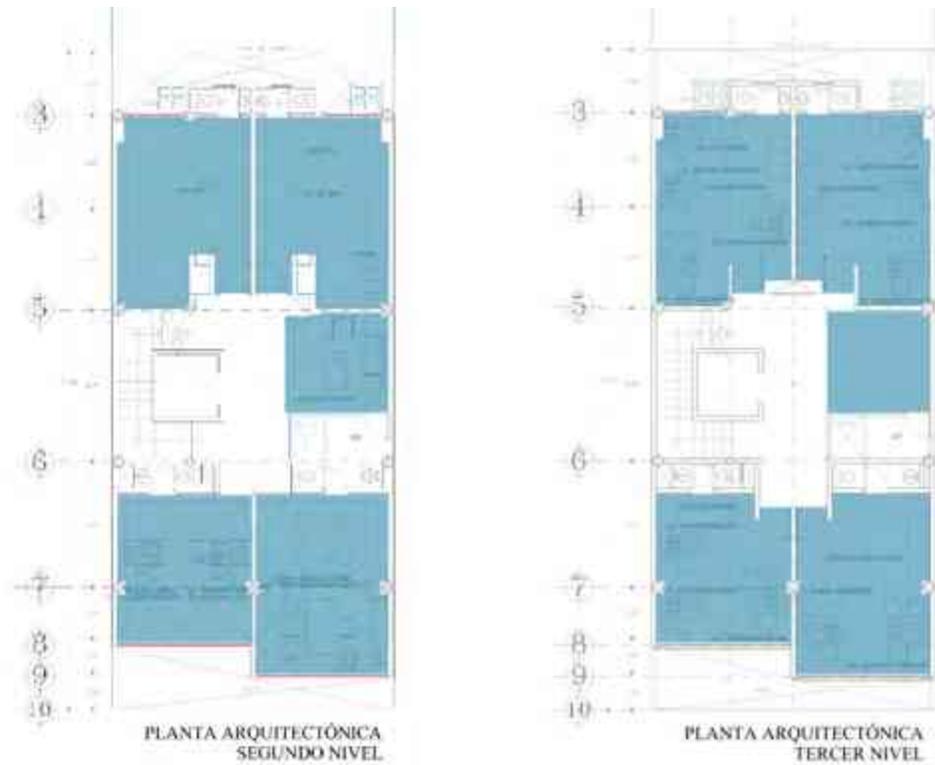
Plantas arquitectónicas del edificio. Fuente: R.R.R.
